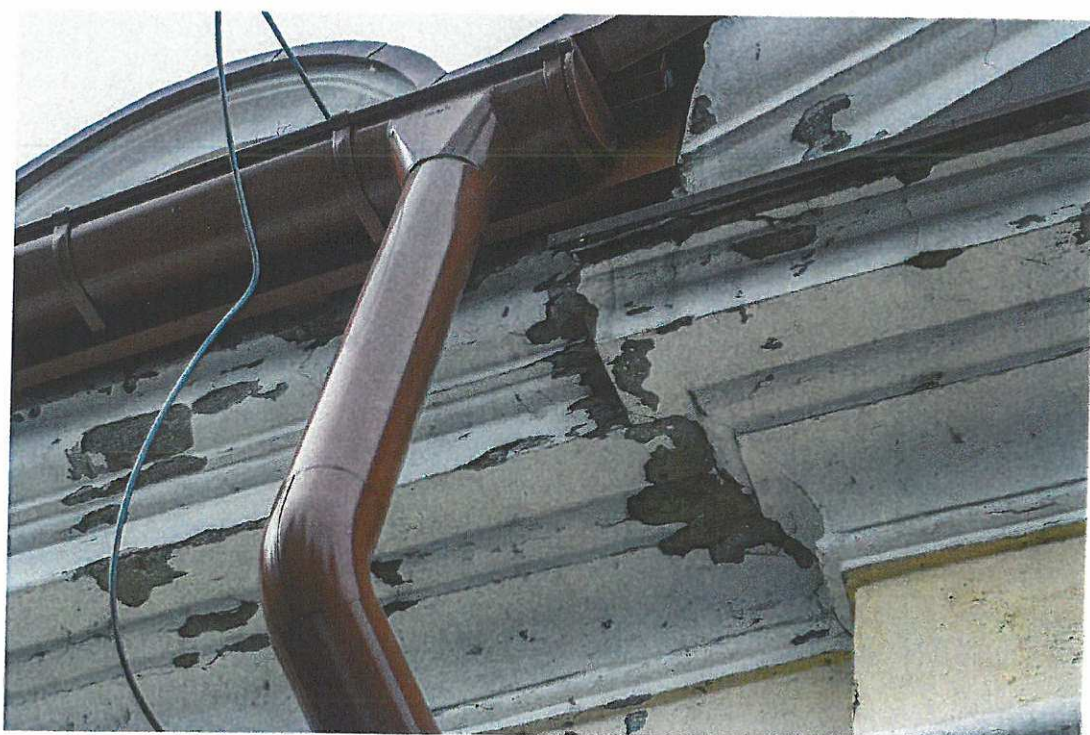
Fot. 15 i 16 pokazują przykładowe pęknięcia wymagające ustabilizowania
